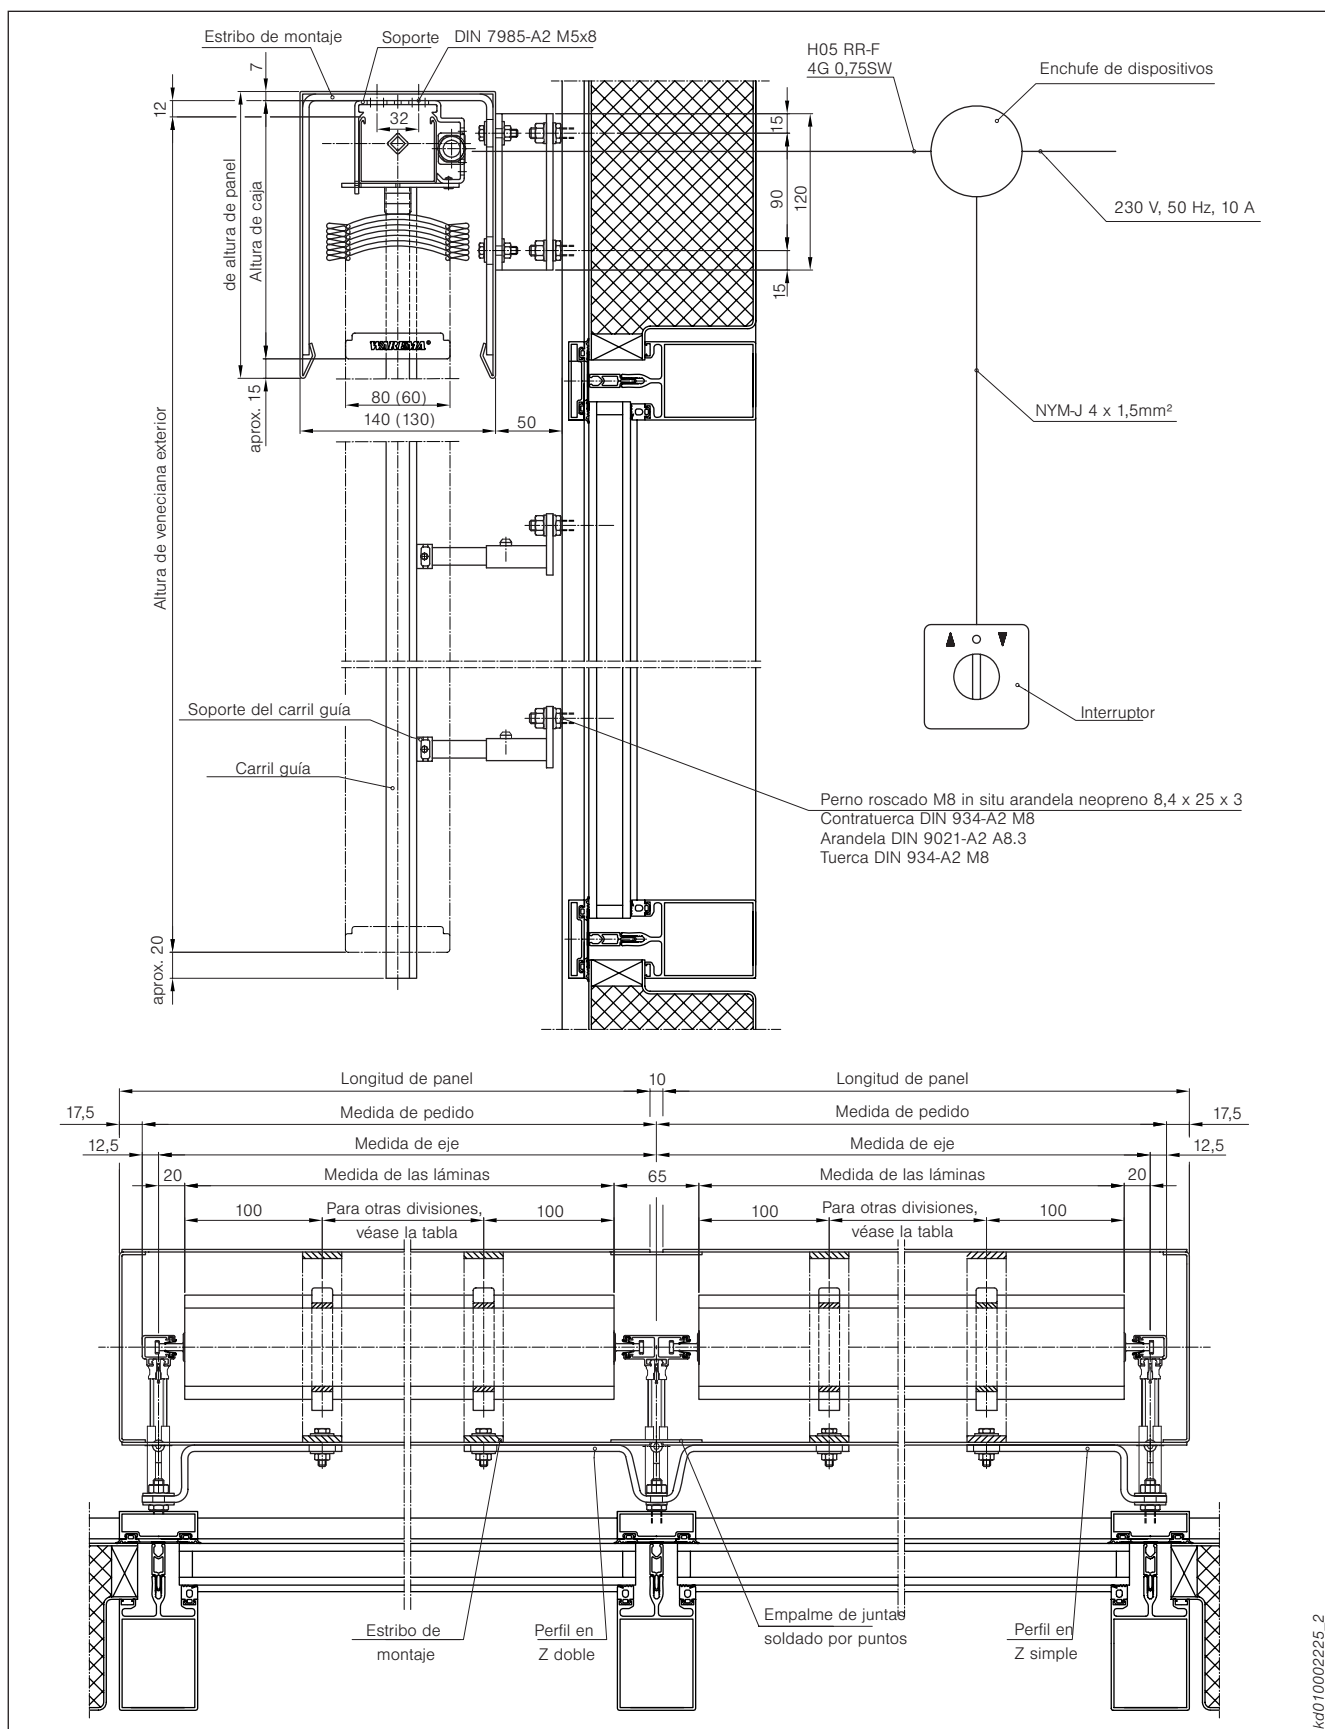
Ejemplo de montaje cortinas venecianas exteriores tipos E 60/80 A6 con galería en "U" en una fachada acristalada
